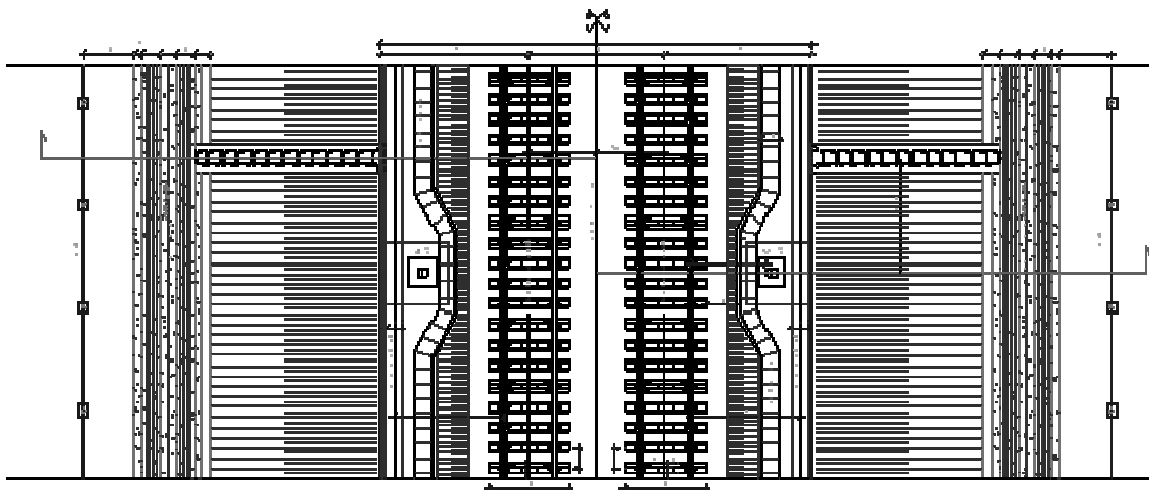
Stralcio planimetrico per sezione tipo ferroviaria in rilevato a doppio binario (piattaforma in retto) con $H_{ril} \leq 6,00$ m
